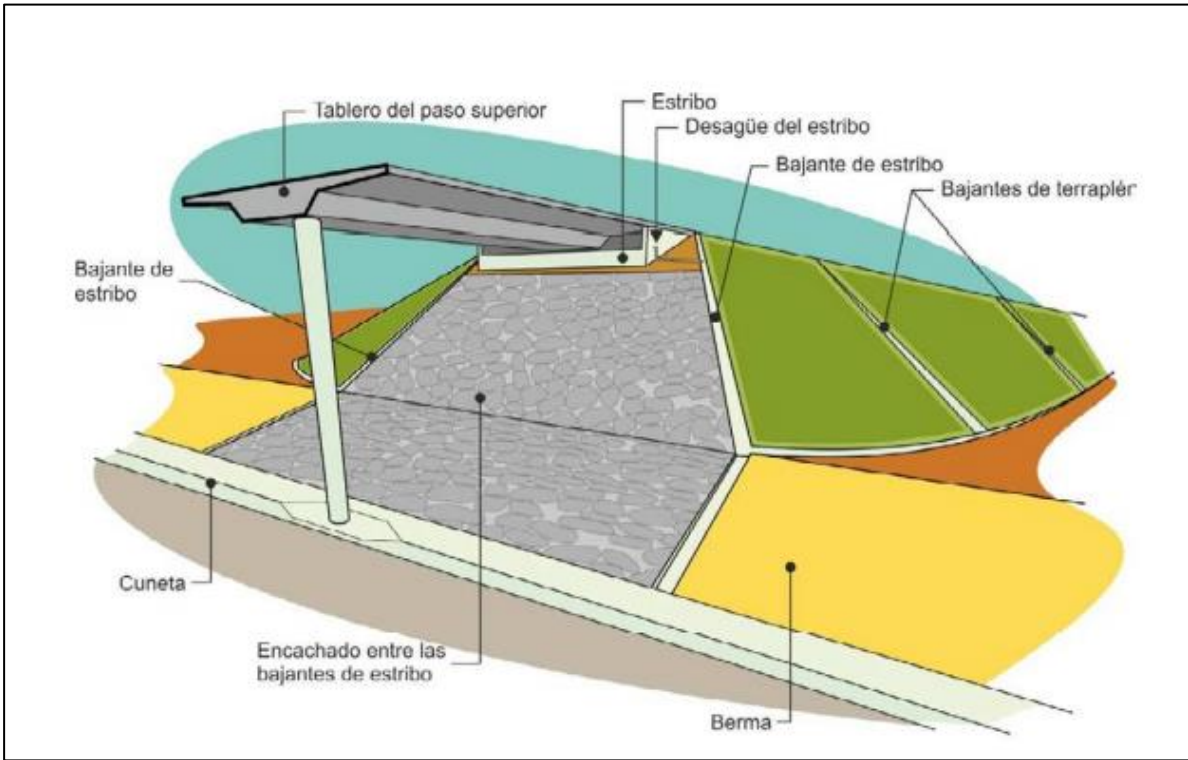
Ejemplo de drenaje de estribos. Fuente: Norma 5.2.- IC Drenaje Superficial.
